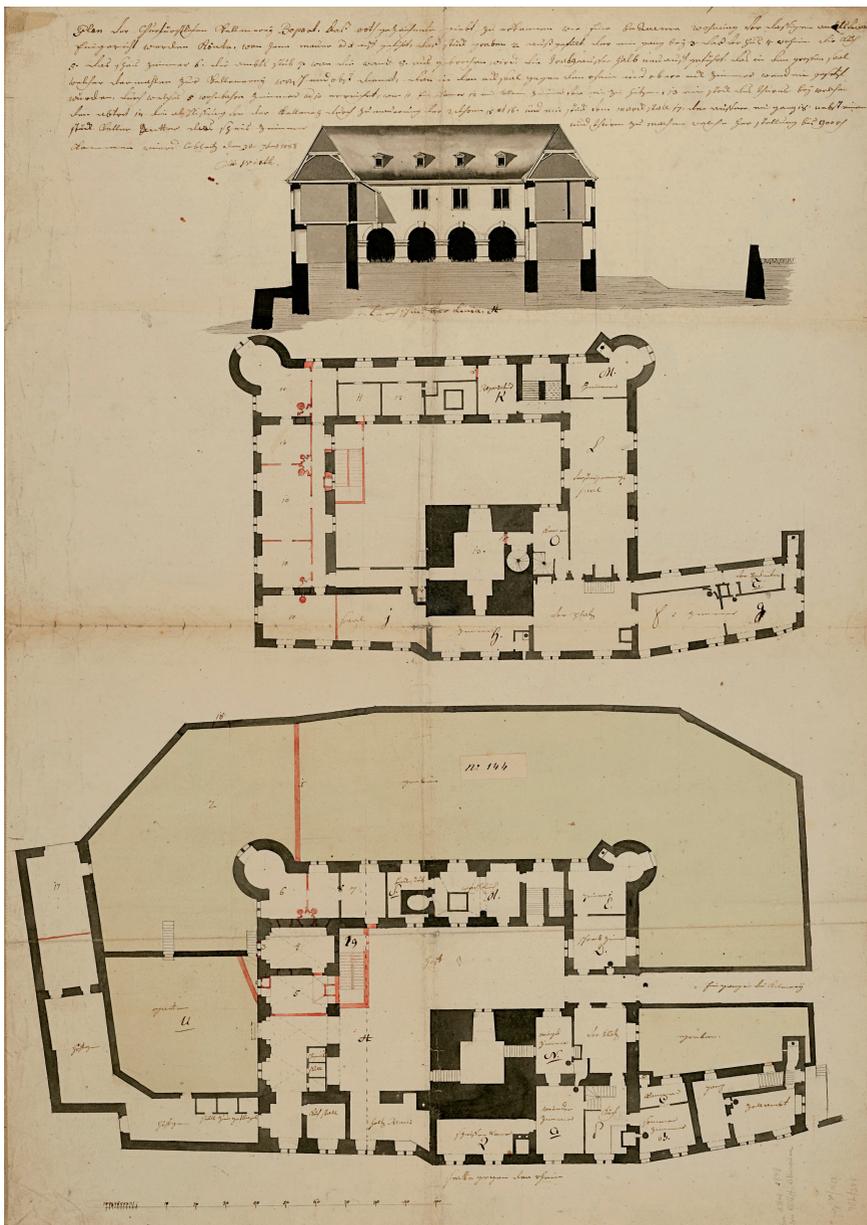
„Plan der churfürstlichen Kellnerey Bopart“, lavierte Federzeichnung von M. Wirth, 3. IX. 1788. Der Plan von M. Wirth aus dem Jahre 1788 mit den Grundrissen des Erd- und des ersten Obergeschosses, einem Nord-Süd-Schnitt mit Blick auf den Ostflügel zeigt den Bestand sowie in rot markiert die beabsichtigten Veränderungen (LAHKO 702, Nr. 246).
